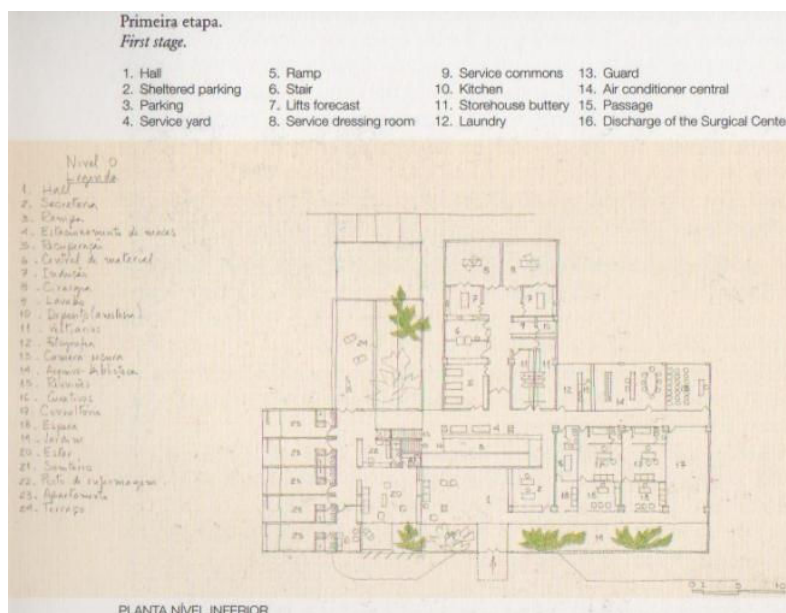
Planta baixa - térreo (LATORRACA, 1999).
